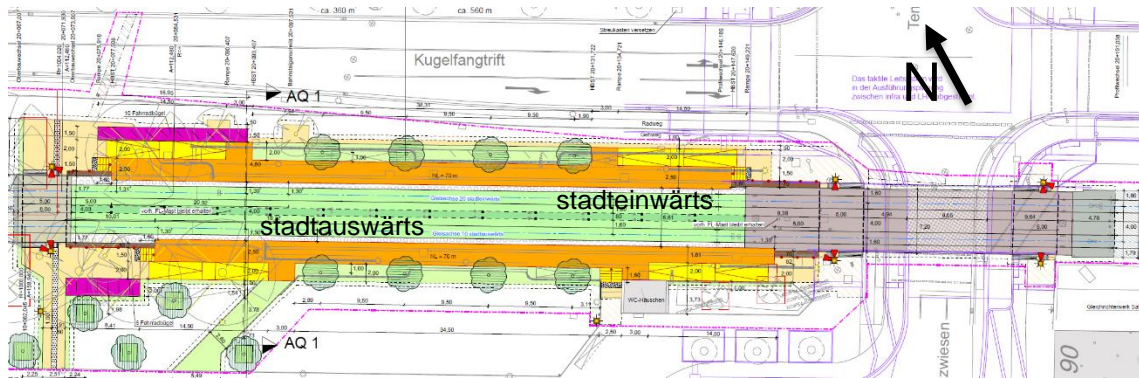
Ausschnitt Lageplan Haltestelle Tempelhofweg (VA4LA01)
